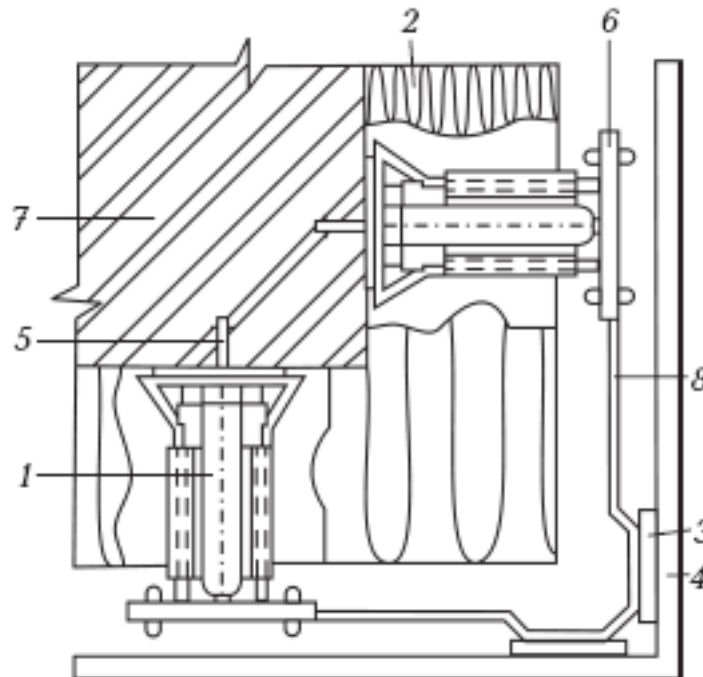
Схема крепления облицовки и плит утепления в зоне наружного угла здания: 1 – кронштейн; 2 – теплоизоляционные плиты; 3 – кляммер; 4 – плитка облицовочная; 5 – утепляемая стена; 6 – заклепка; 7 – анкерный дюбель; 8 – гнутый уголковый профиль
